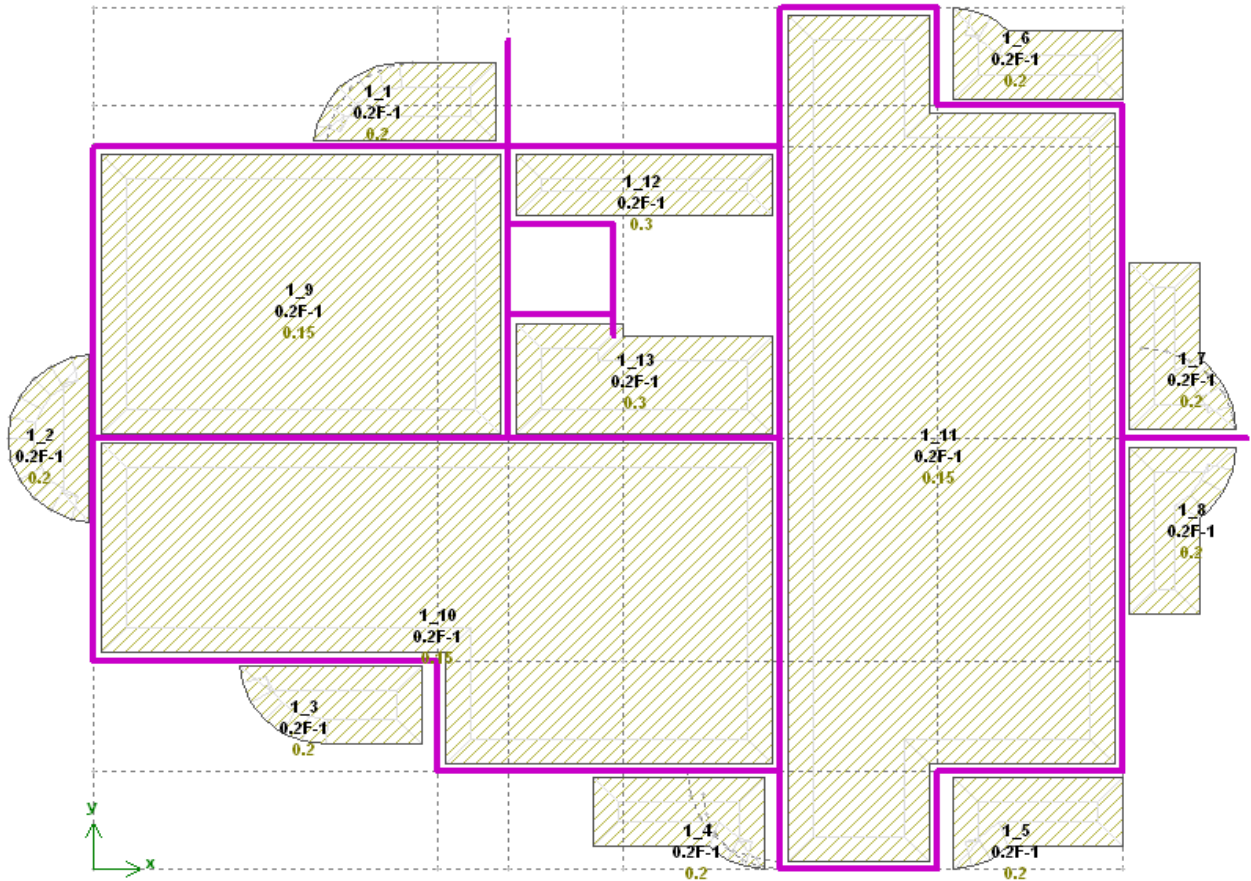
Розрахункова схема перекриття будівлі
